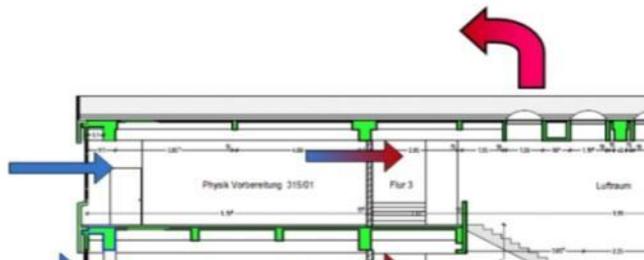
Zentrale Dachlüfter im Treppenhaus mit Nachströmung kühler Frischluft über Oberlichtfenster
